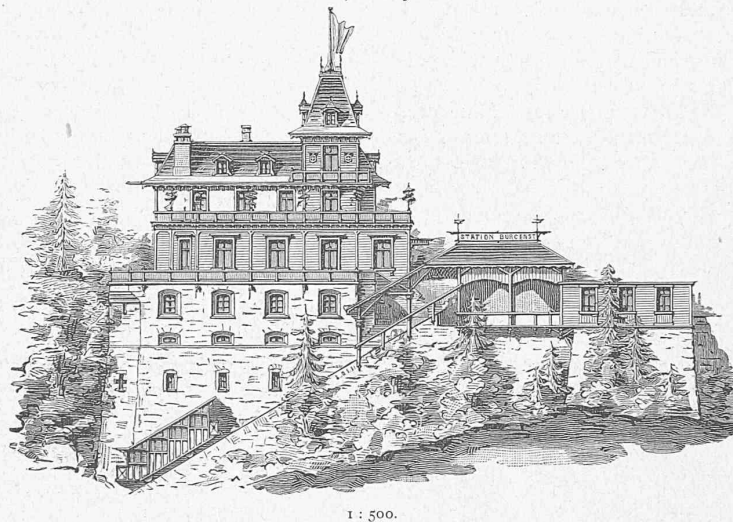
Bürgenstockbahn. Obere Station. Ost-Façade.
